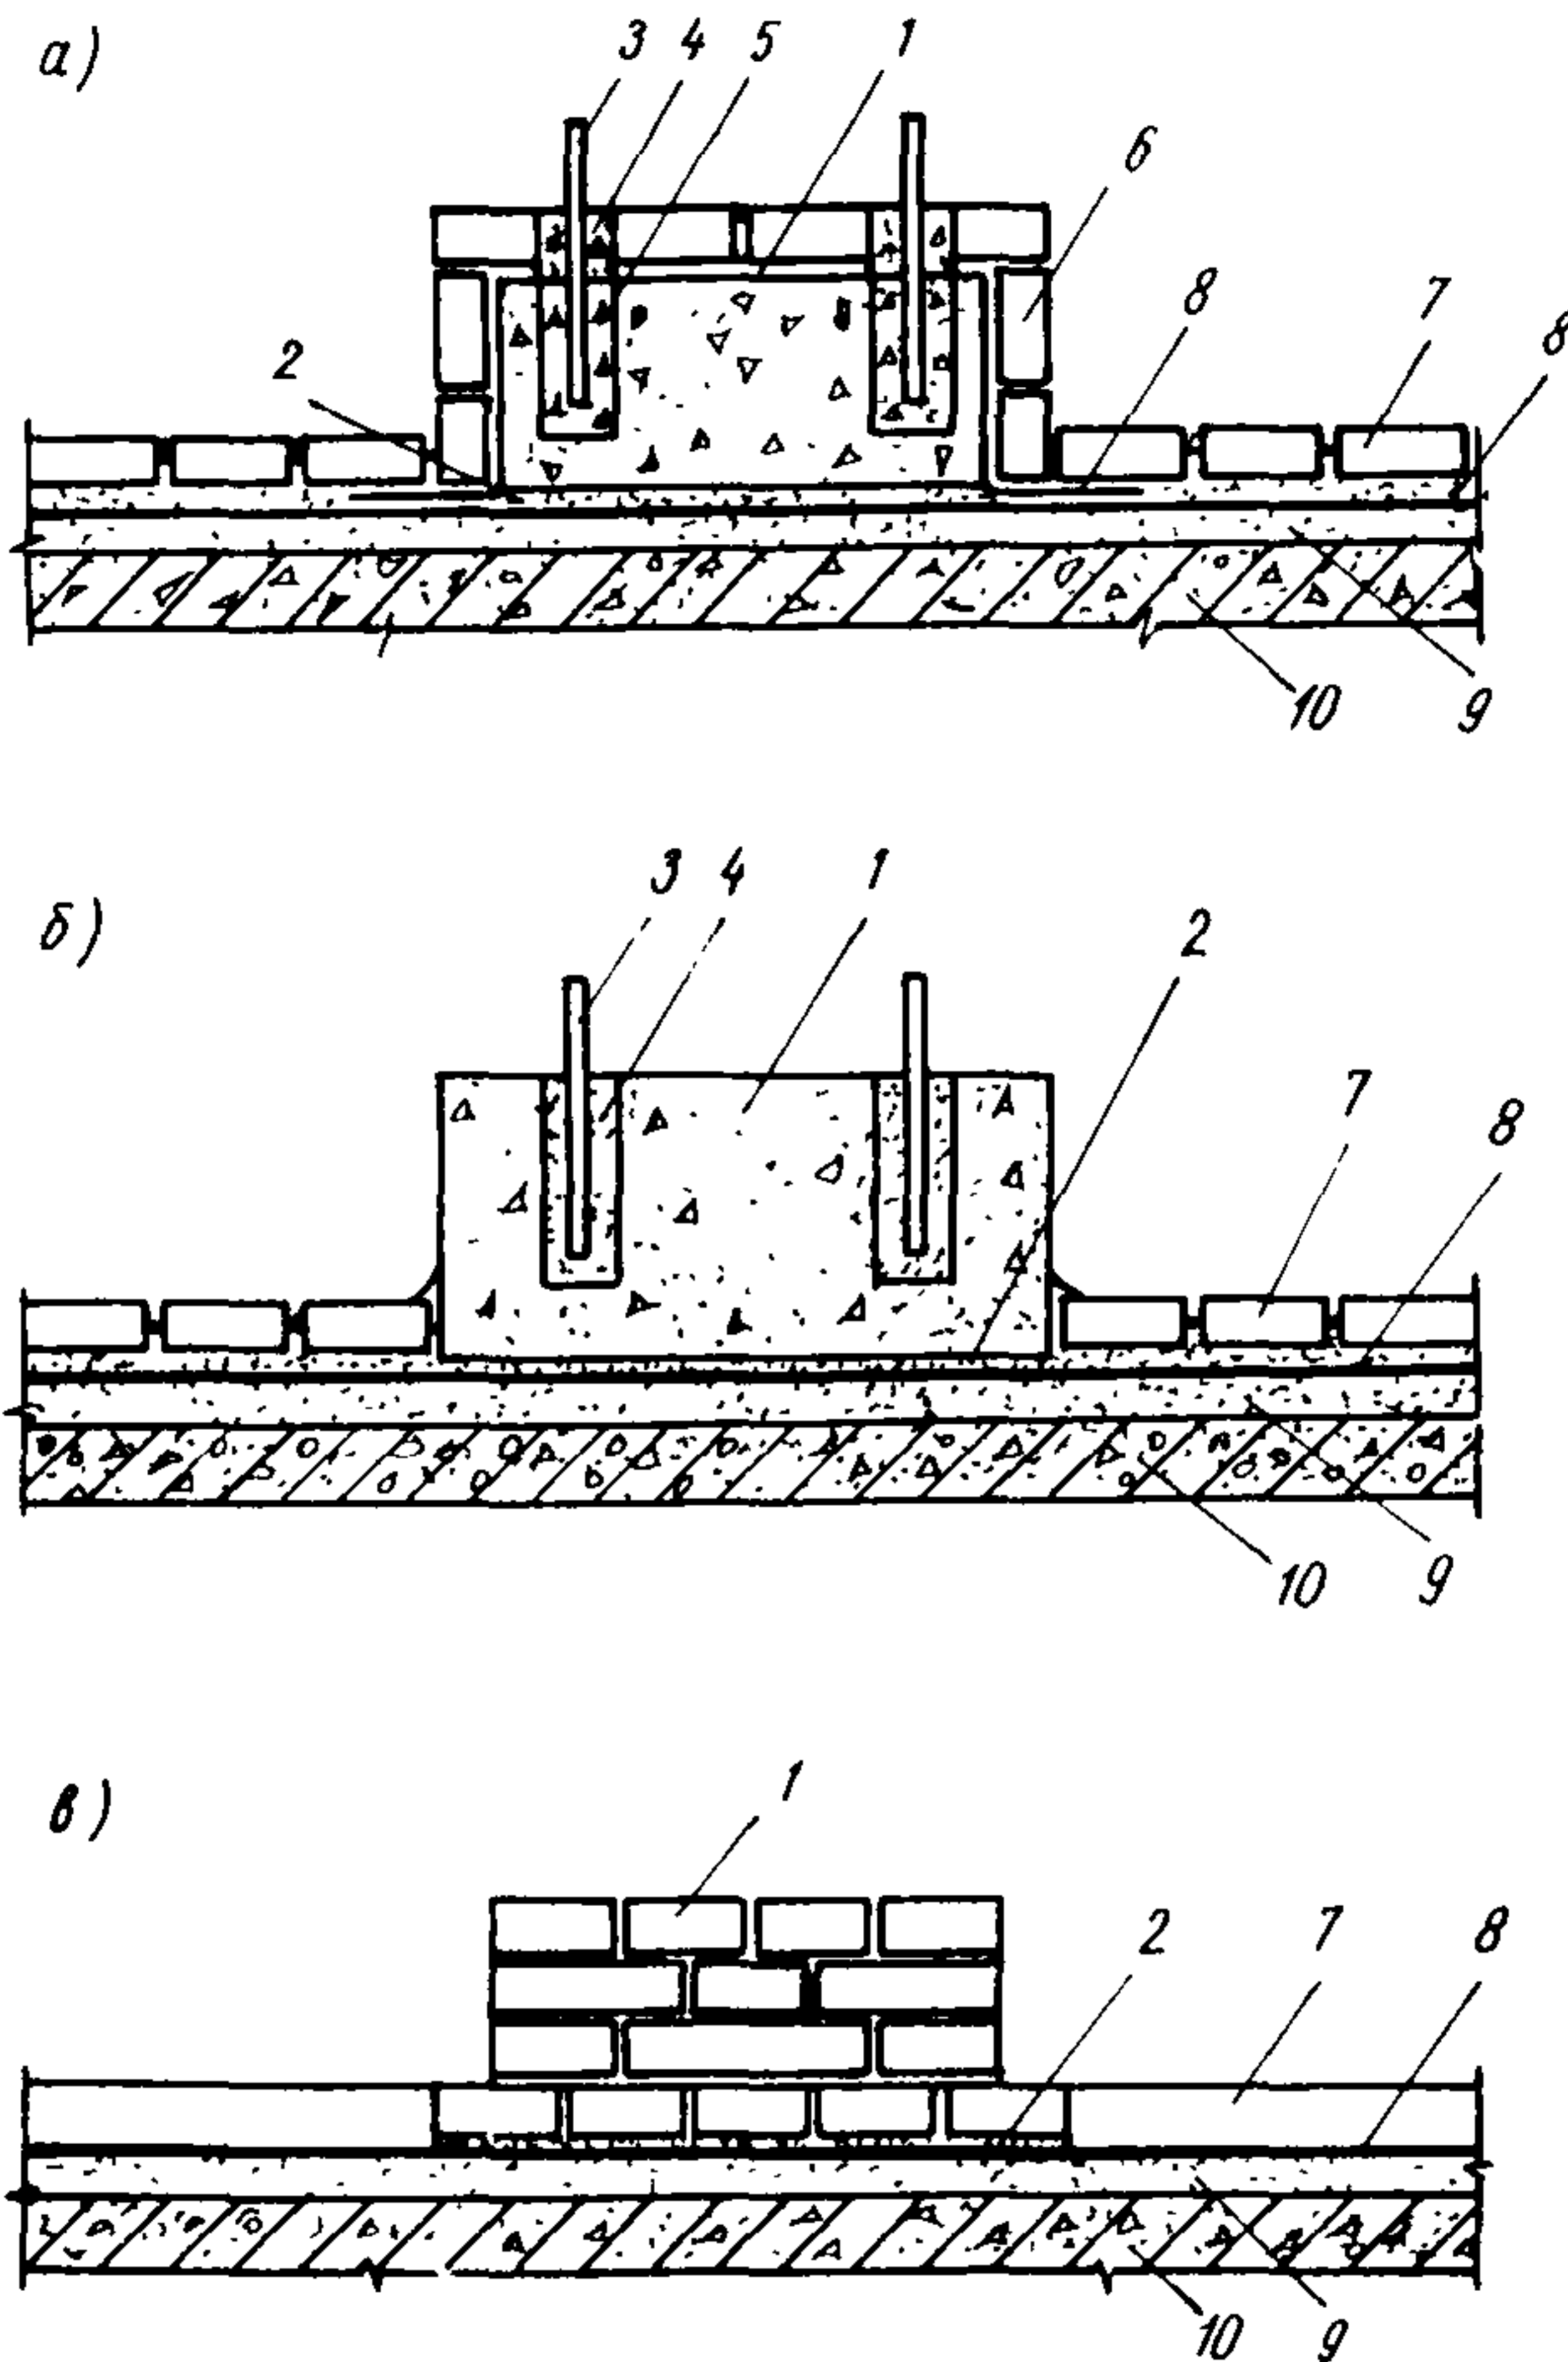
Рекомендуемые конструкции фундаментов под оборудование
